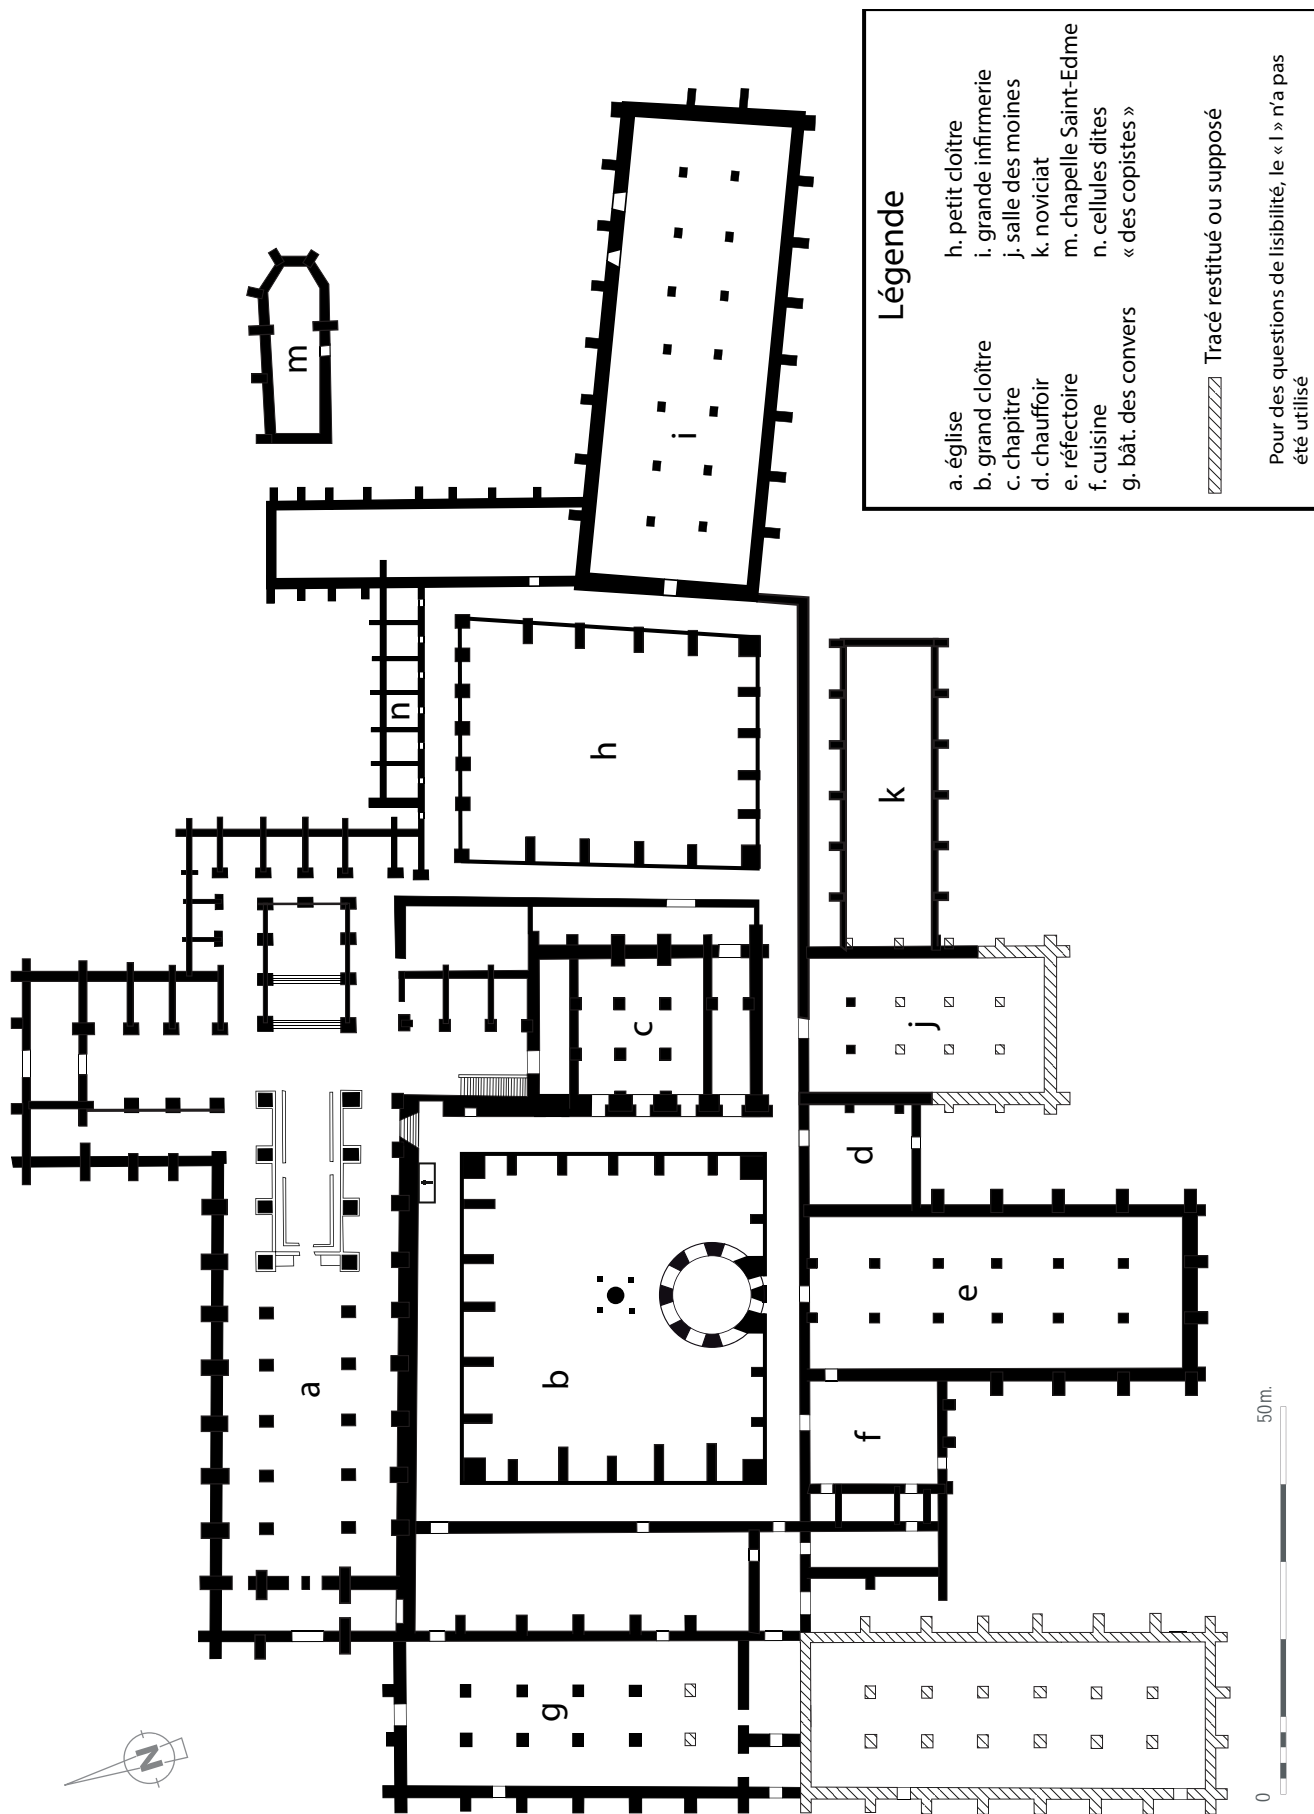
Plan restitué de Cîteaux à la fin du XV^e s.
